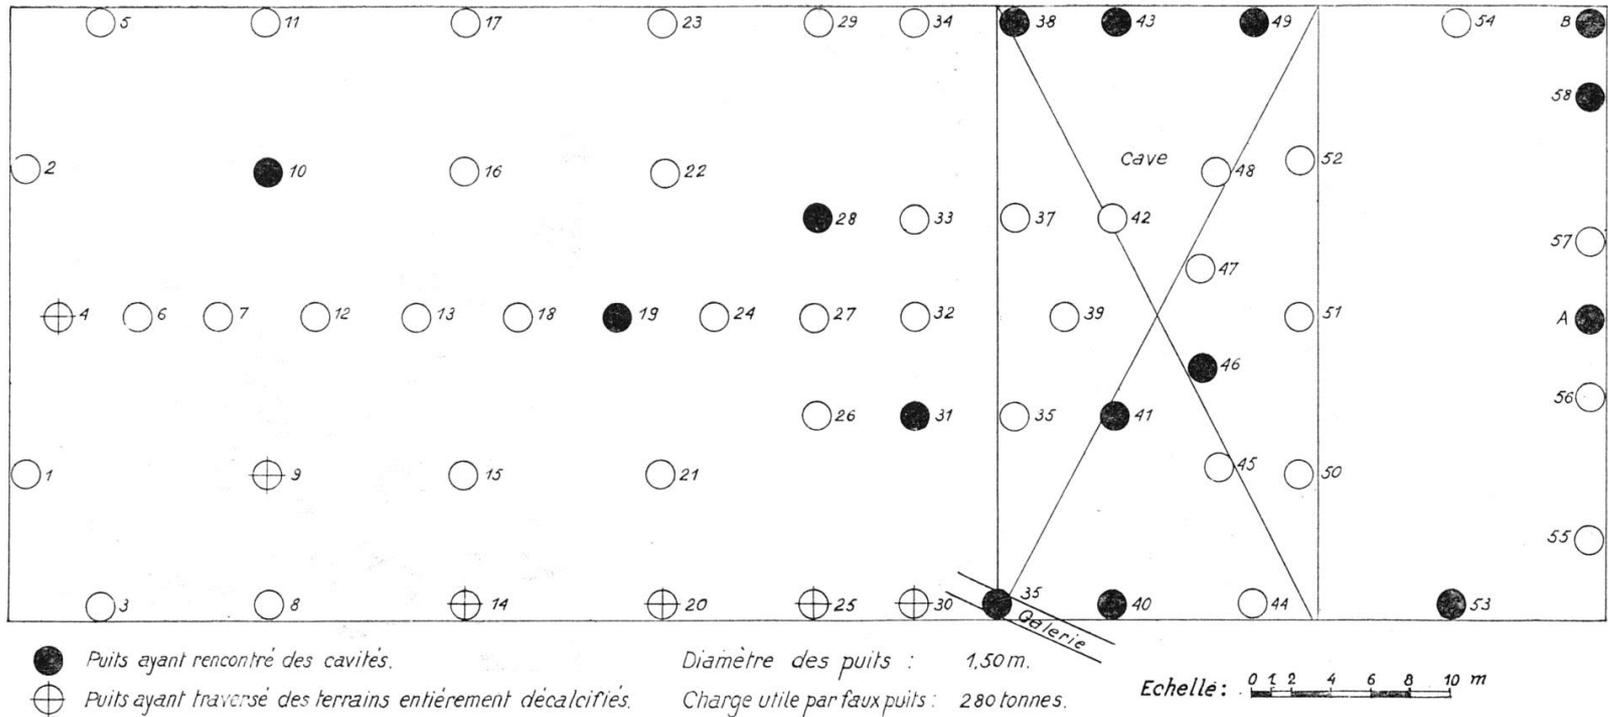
U.L.B. Institut des Constructions Civiles. Fondations. Implantation des faux puits.
